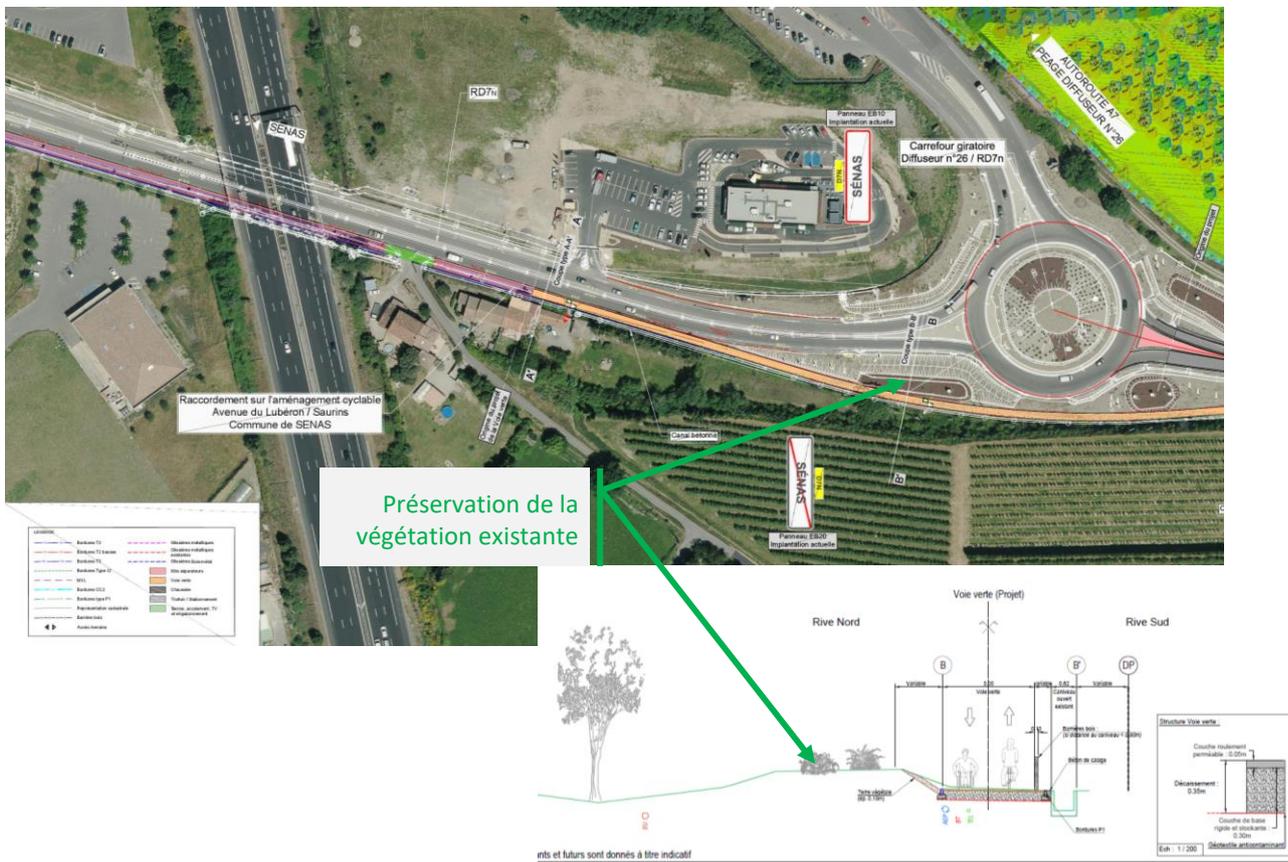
PLAN D'AMENAGEMENT (PLANCHE 1/3) / PROFIL EN TRAVERS TYPE
